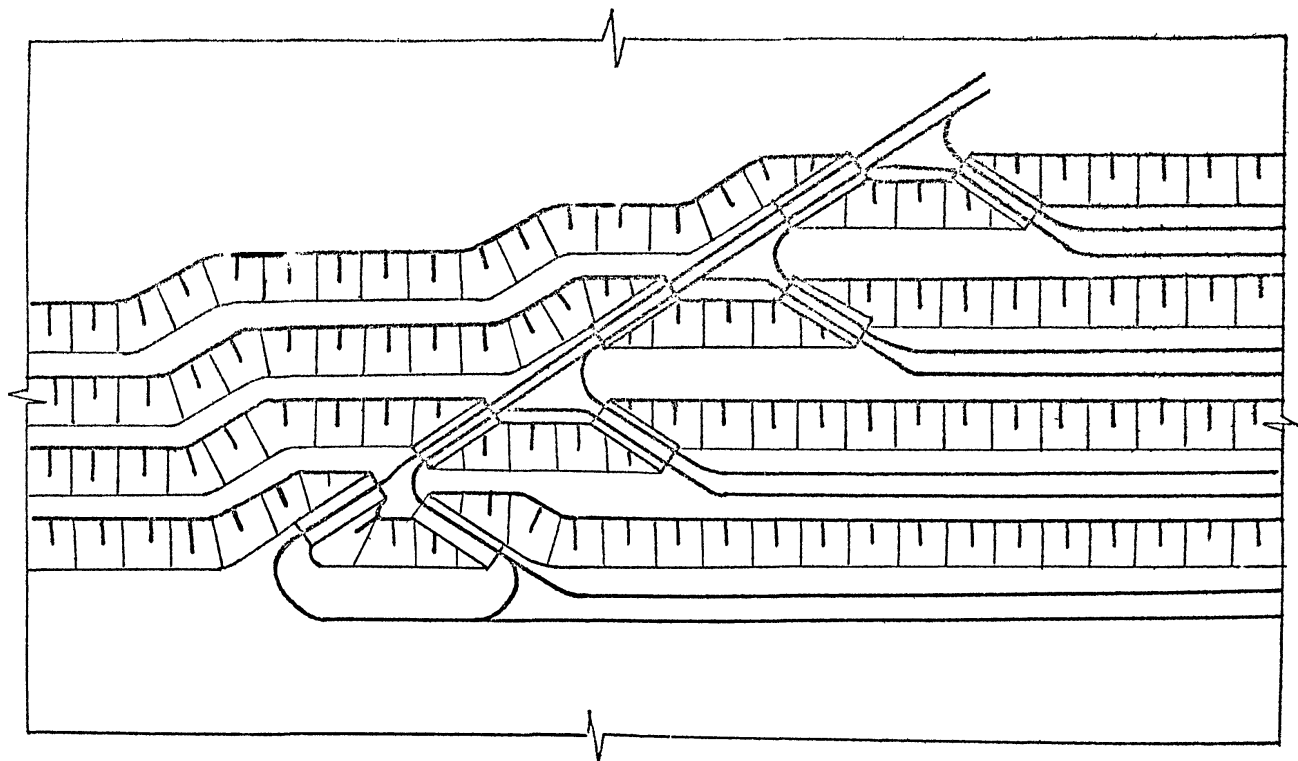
Схема вскрытия с односторонним примыканием, подачей порожних поездов снизу и дополнительными съездами на каждом горизонте.
